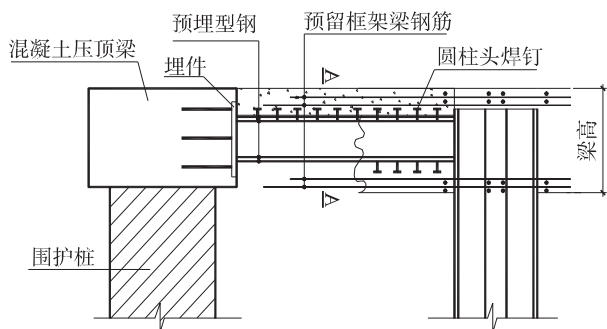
围护墙与顶板用型钢混凝土组合支撑连接
